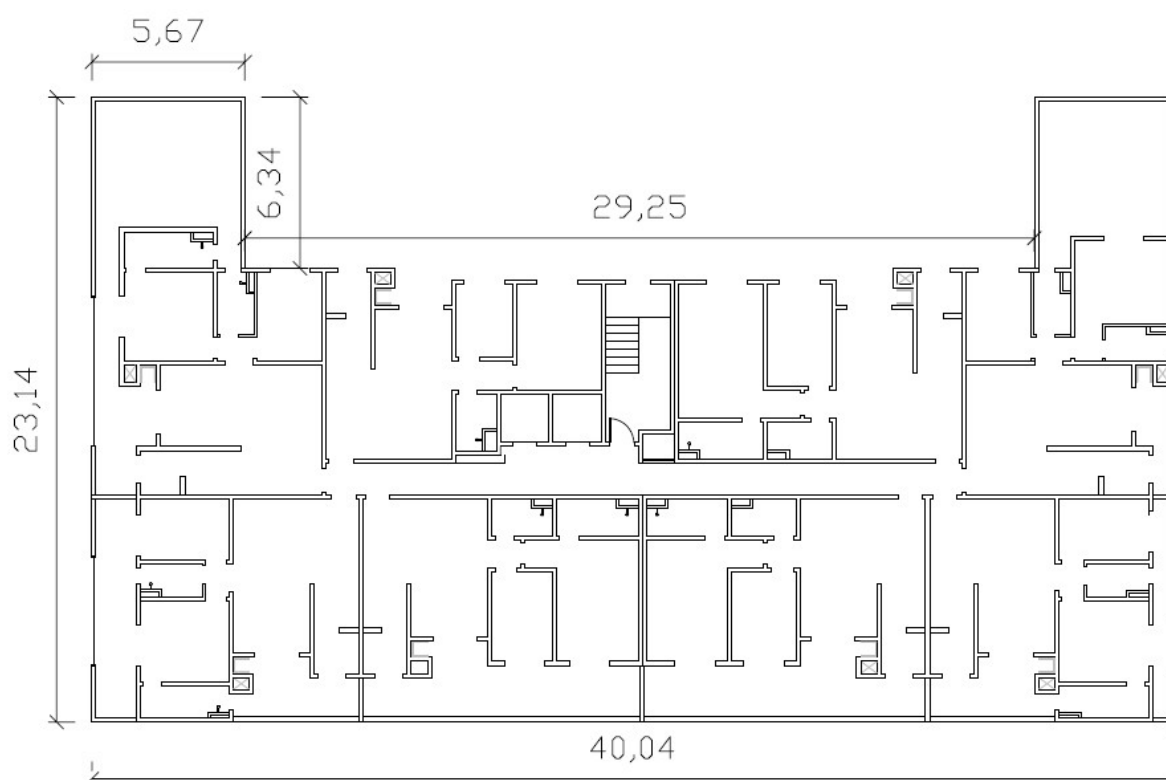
Planta baixa da laje de transição em estudo. (Autor, 2019)
